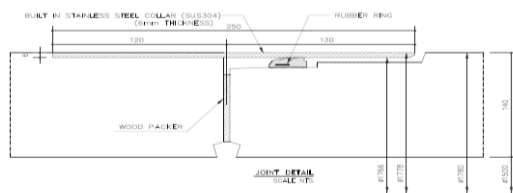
Standard Steel Collar Corrugated Galvanize (Ring baja bergelombang galvaniz) pipa jacking dengan Japan Sewerage Works Associations System (JSWAS) 2018 , dengan ukuran pipa Jacking diameter 800 sampai dengan 2000 mm
